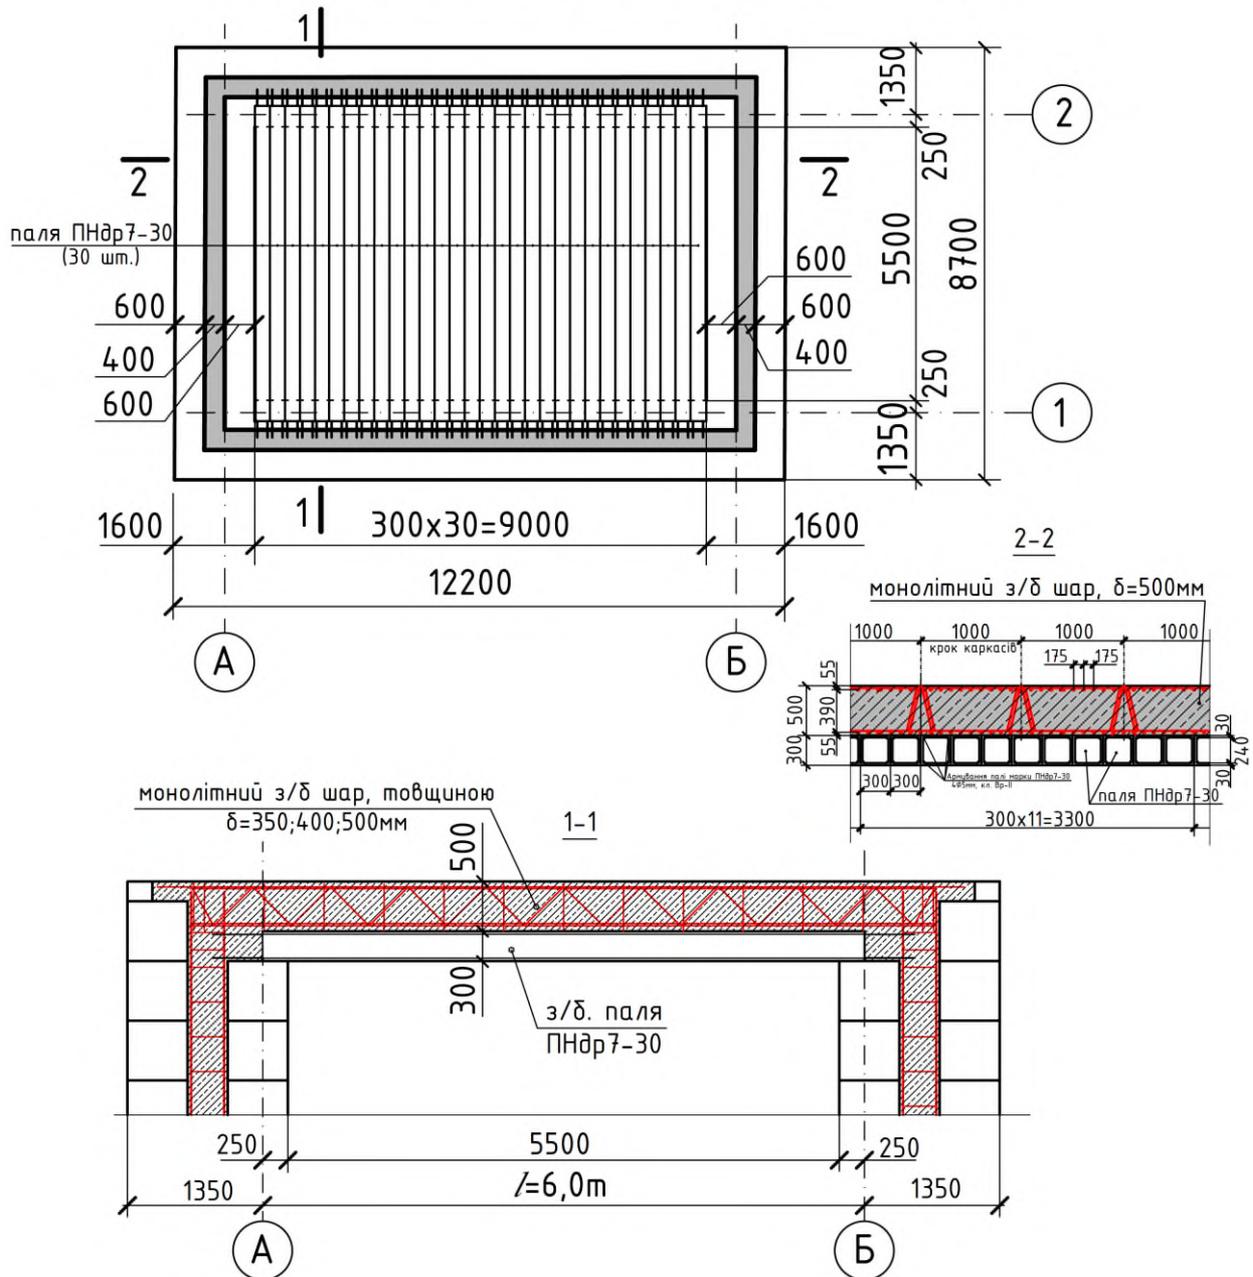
Конструктивне рішення збірно-монолітного перекриття за другим варіантом зі збірними елементами із залізобетонних палей марки ПНдр7-30
